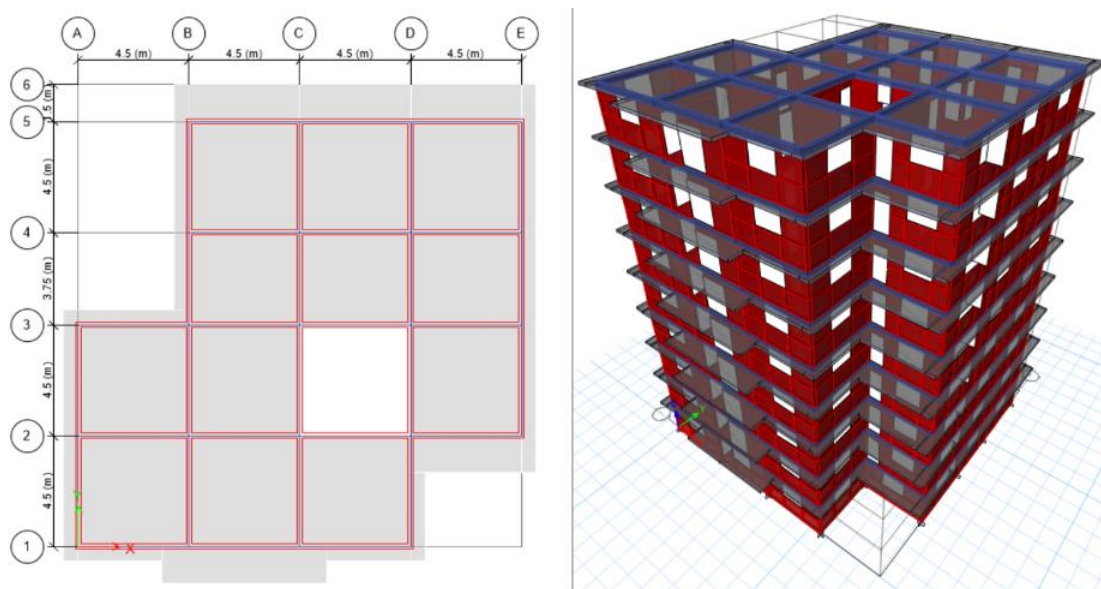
Vista en planta y en elevación de la edificación de mampostería reforzada.
